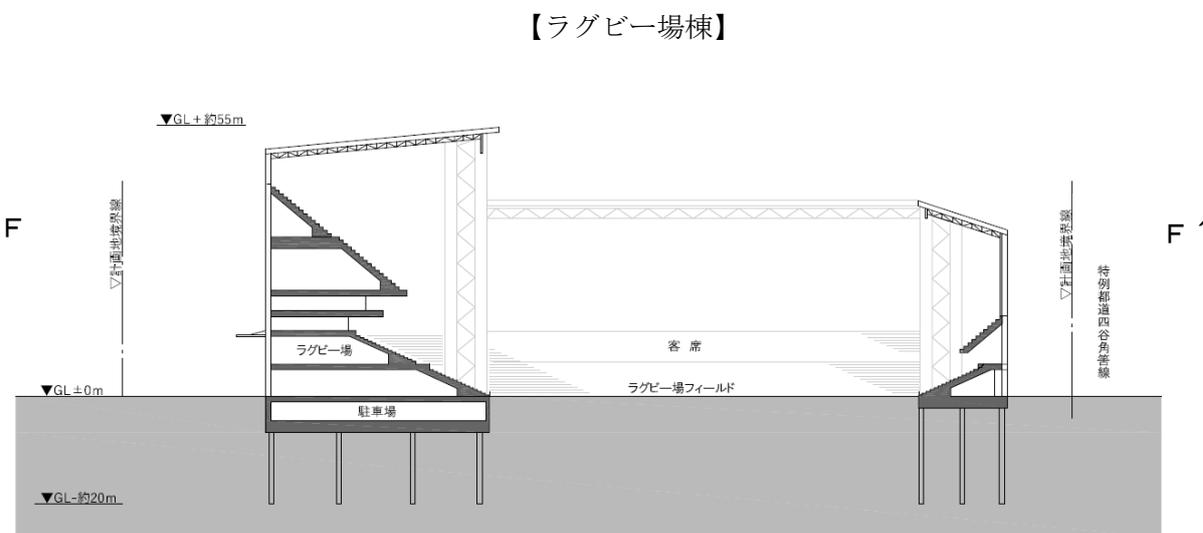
(1) 断面図(F-F') (変更後) S=1/1,600
